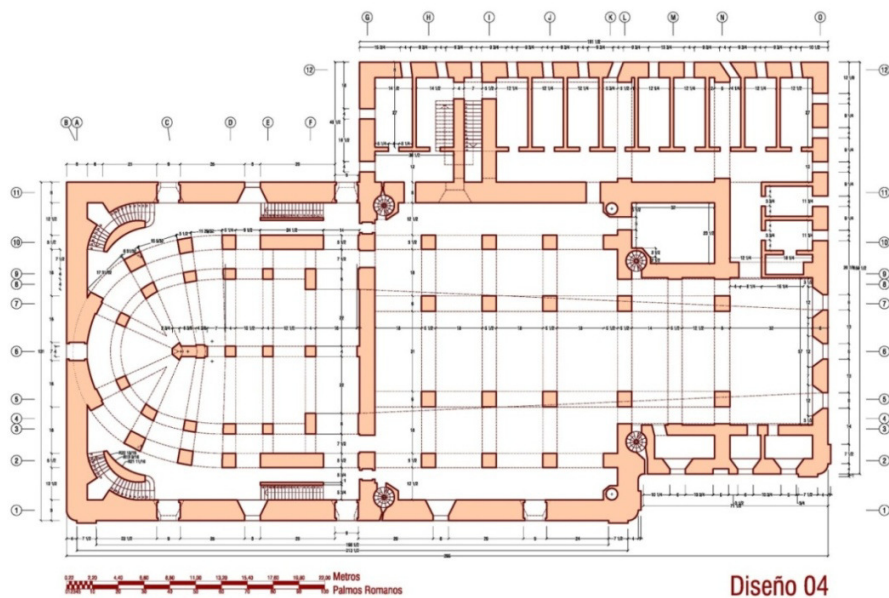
Reconstituição com medidas da planta do piso térreo (cave) da Ópera do Tejo (seg. Januário).
